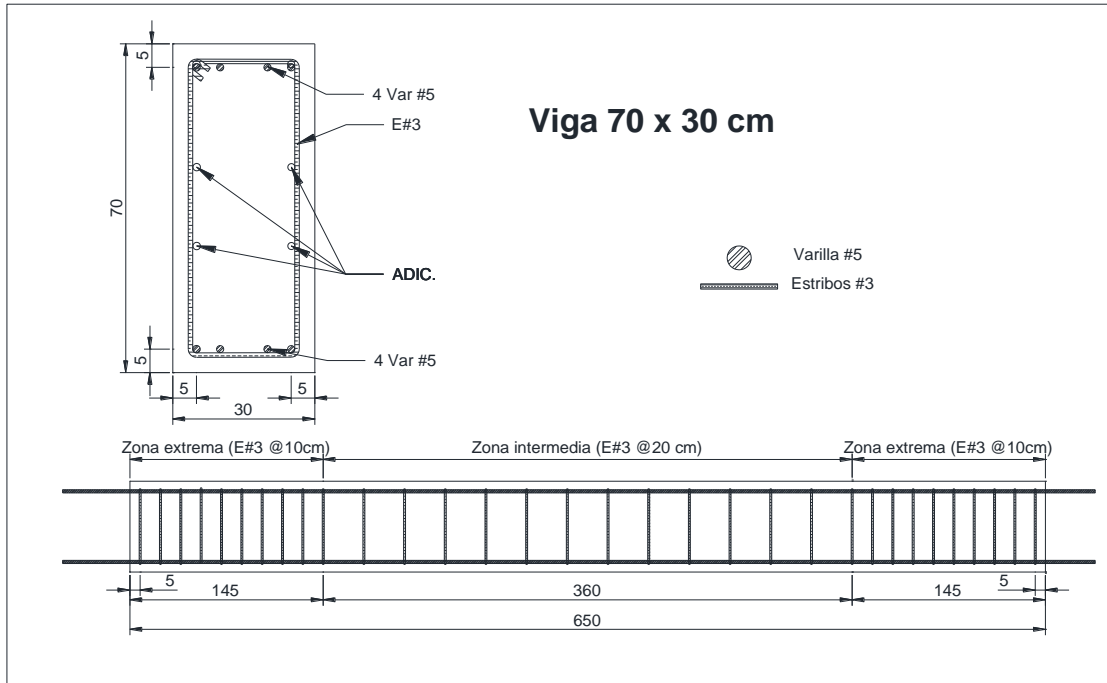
Armado tipo de la viga con sección transversal de 70 x 30 cm.
